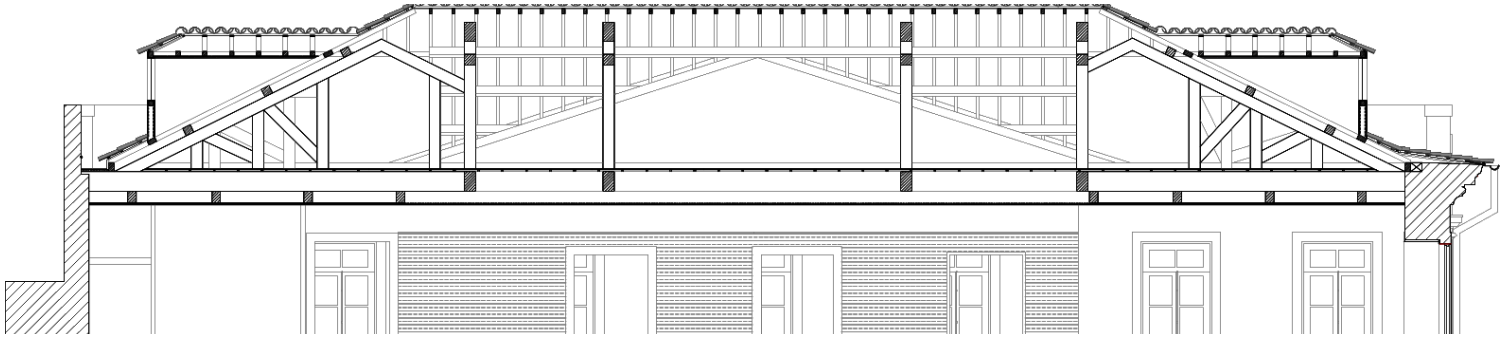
Corte Longitudinal da cobertura original em Madeira;
